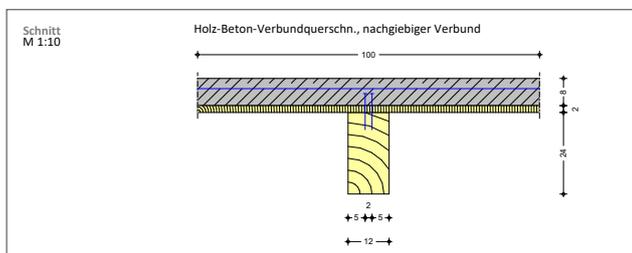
Querschnitt einer Holz-Beton-Verbunddecke
